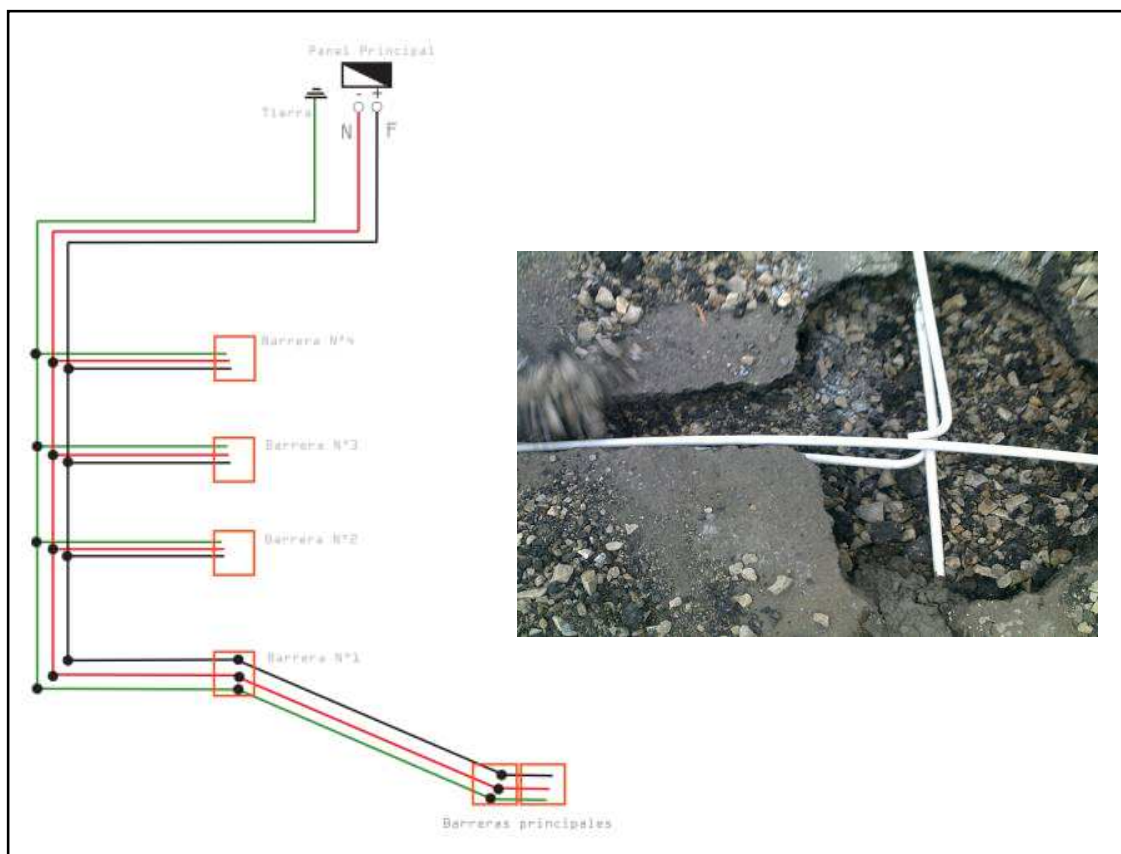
Tubería para cables que energizarán las torres de las barreras
